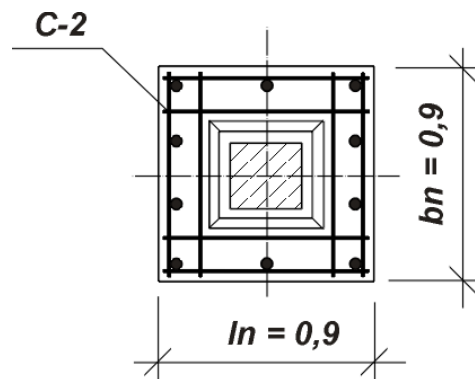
Схема армирования подколонника арматурной сеткой С-2
